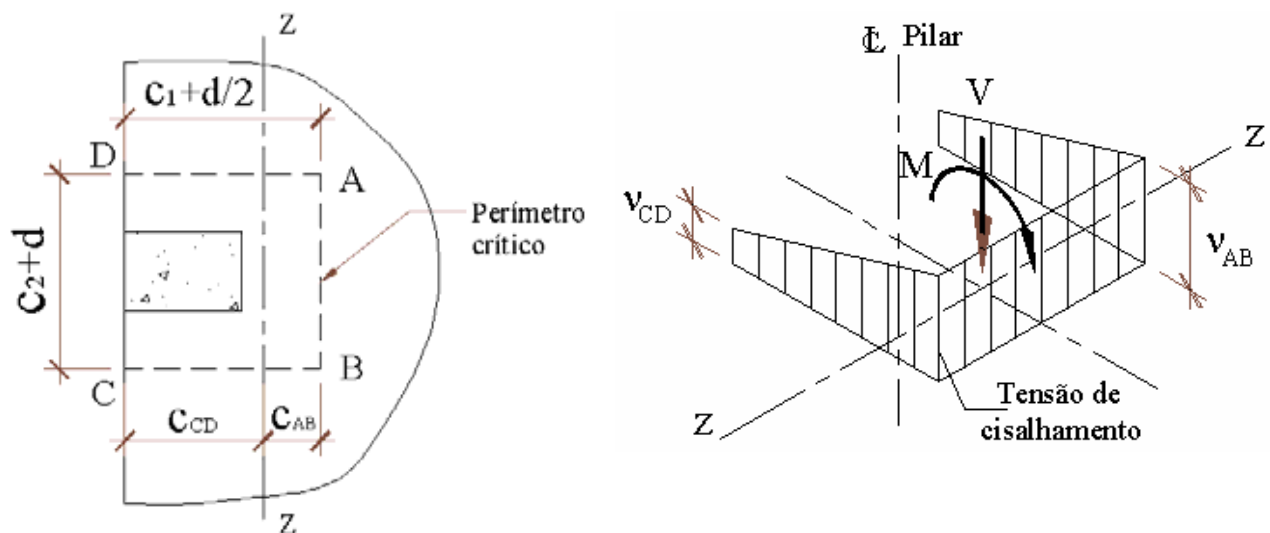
Distribuição de tensões de cortante para a ligação do pilar de extremidade
